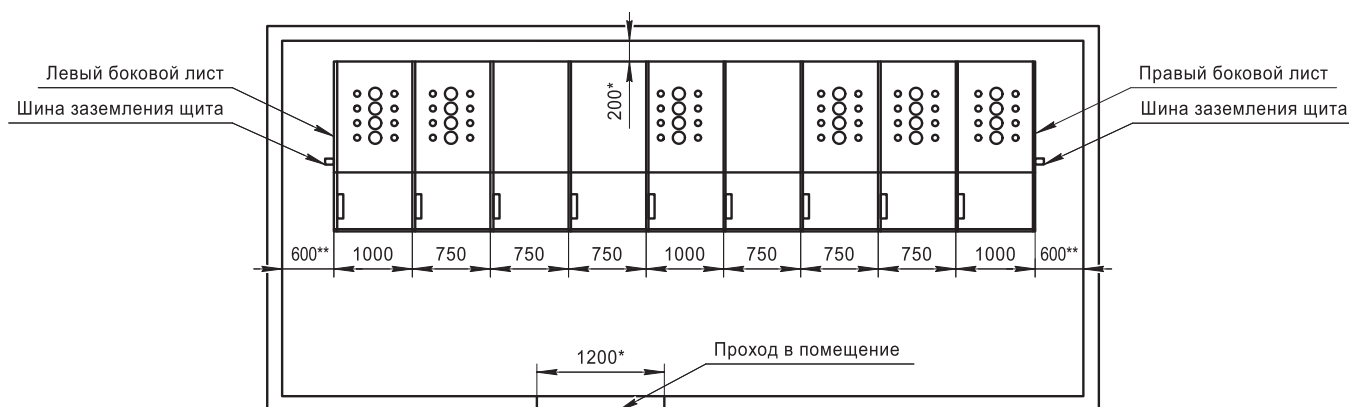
Монтаж кабелей с использованием кабельного полуэтажа.
